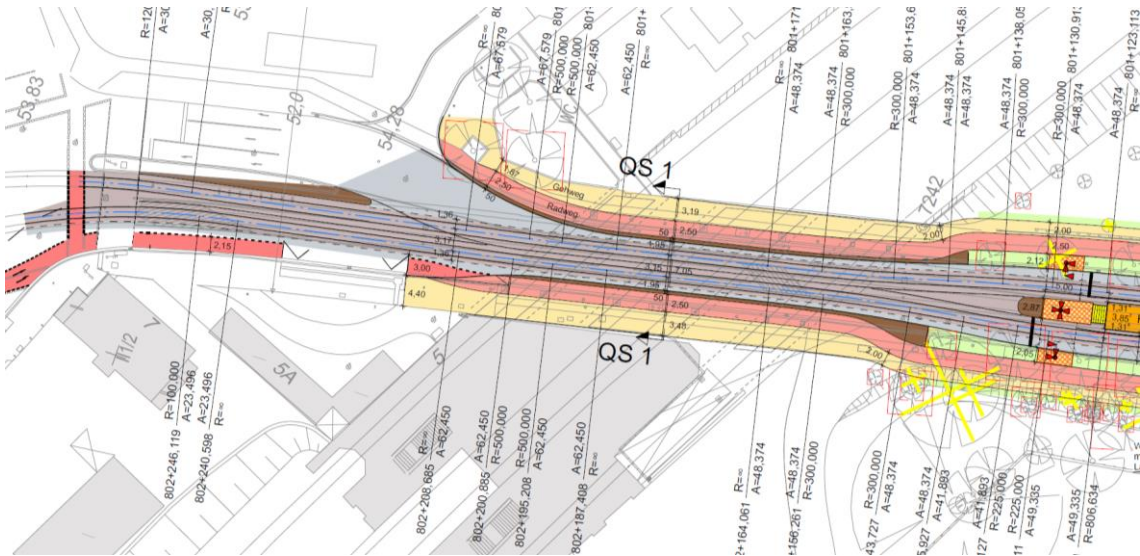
Nordausschnitt aus dem Lageplan Variante 8a
